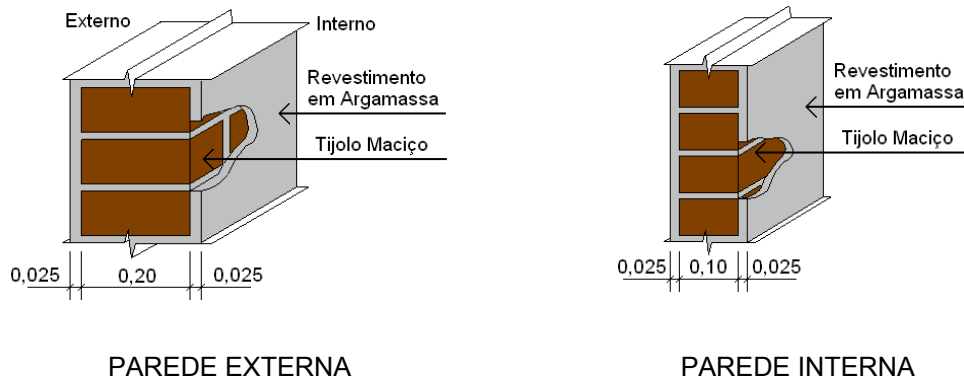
Detalhe construtivo das alvenarias externa e interna – Ambiente 3.
